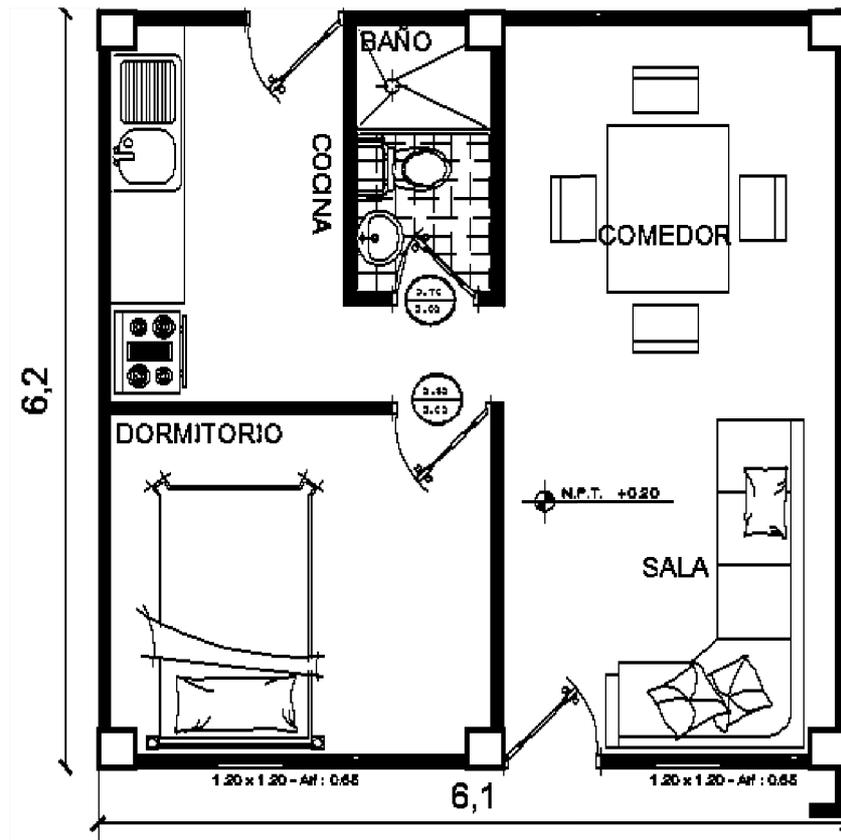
Planta arquitectónica de "vivienda tipo".
